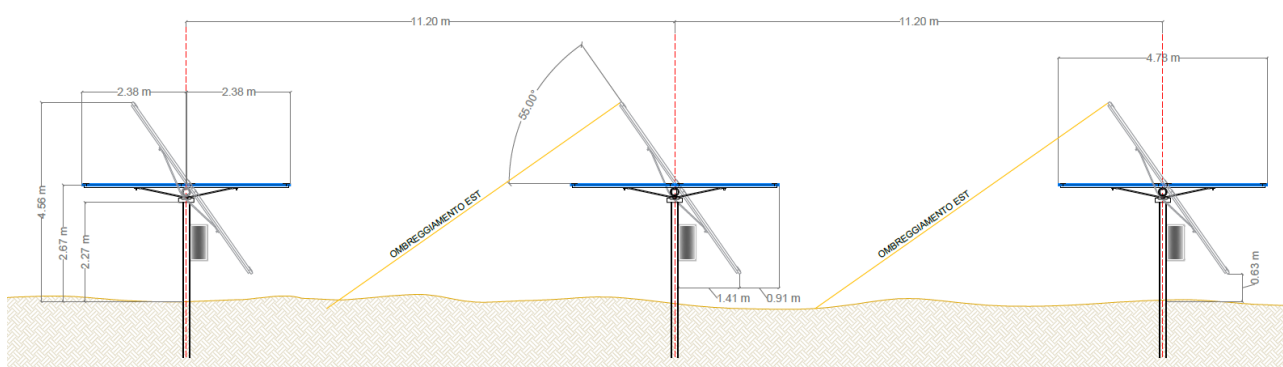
Vista frontale con rotazione di 55° est e distanza longitudinale tra le strutture
